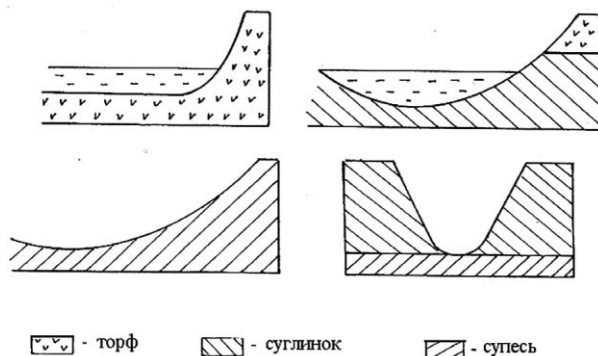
Устойчивые поперечные сечения осушительных каналов
